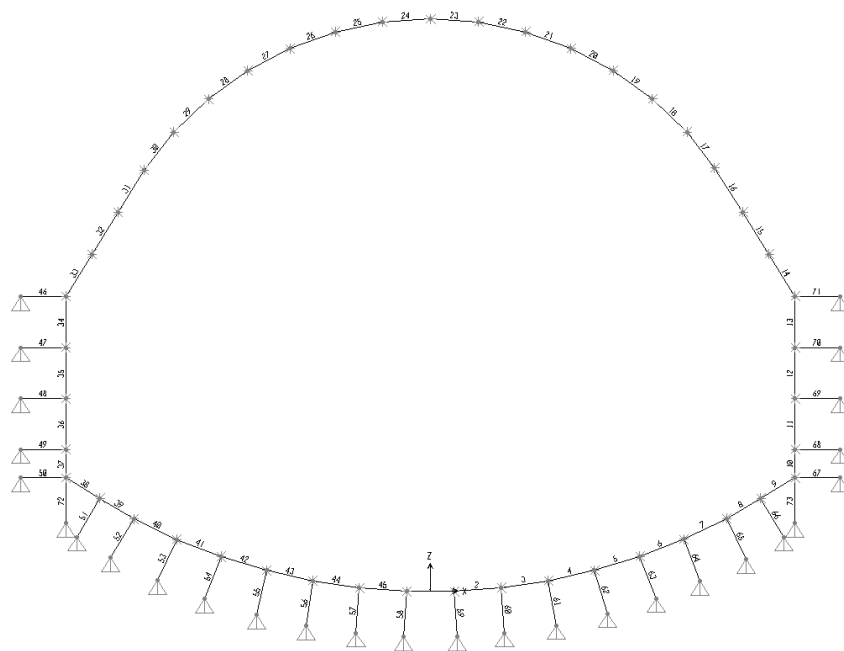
Discretizzazione per elementi finiti tipo "Beam": numerazione elementi strutturali
